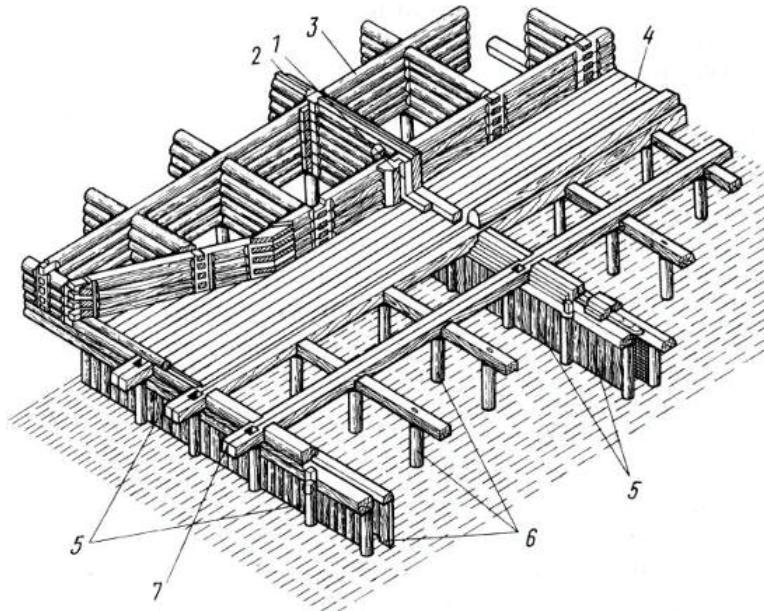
Свайный флотбет ряжевой плотины [70]: 1 – паз для щита; 2 – шпунтовый простенок; 3 – ряжевый береговой устой; 4 – пол водобоя; 5 – шпунтовые стенки; 6 – маячные сваи; 7 – связывающий продольный брус
